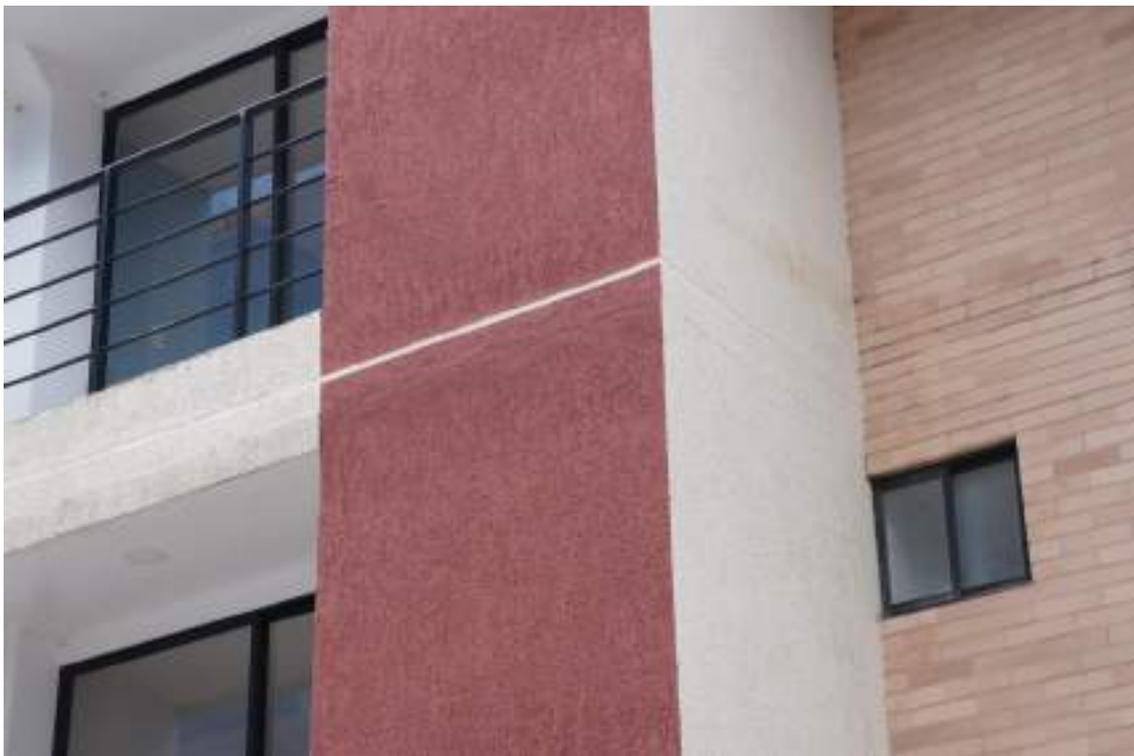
Detalles afectaciones fachada principal, Septiembre 2022
